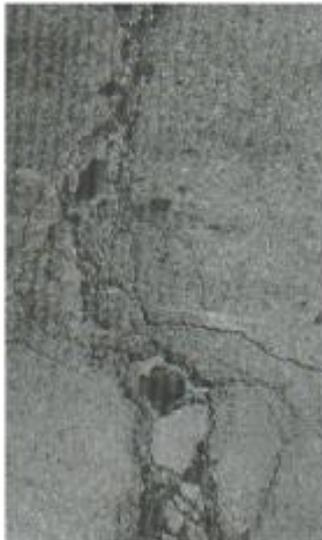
c. Grietas longitudinales y transversales (No PCC) de alta severidad.
